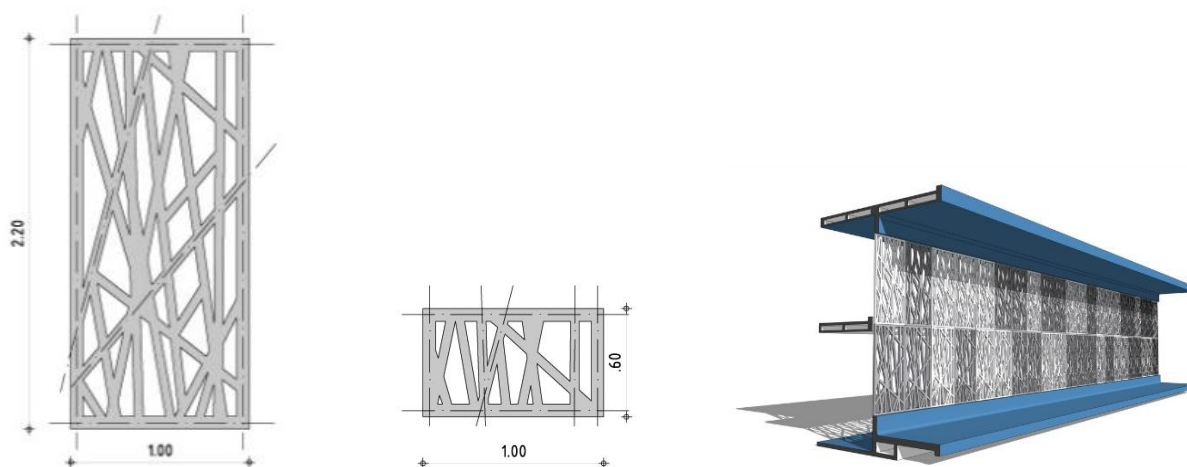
Módulo do painel vazado; Painel aplicado, Escola Flor do Campo
